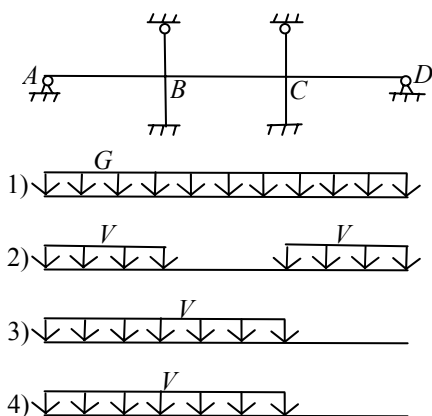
Расчетная схема и варианты загрузки вертикальными нагрузками рамы нижнего этажа (подвала)
